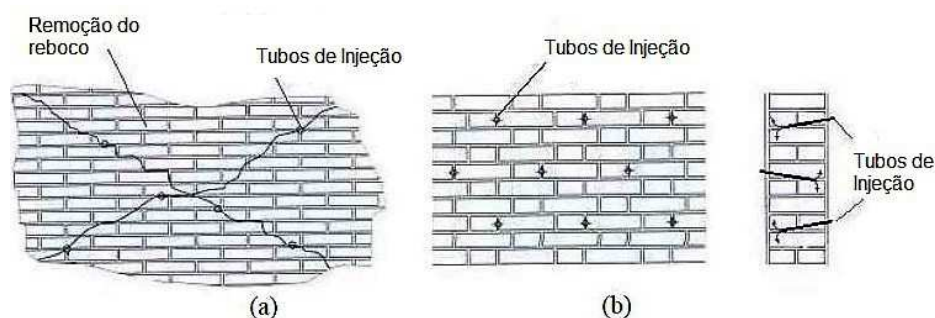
Injeção de alvenarias: (a) selagem de fissuras e (b) consolidação do material.[8]
